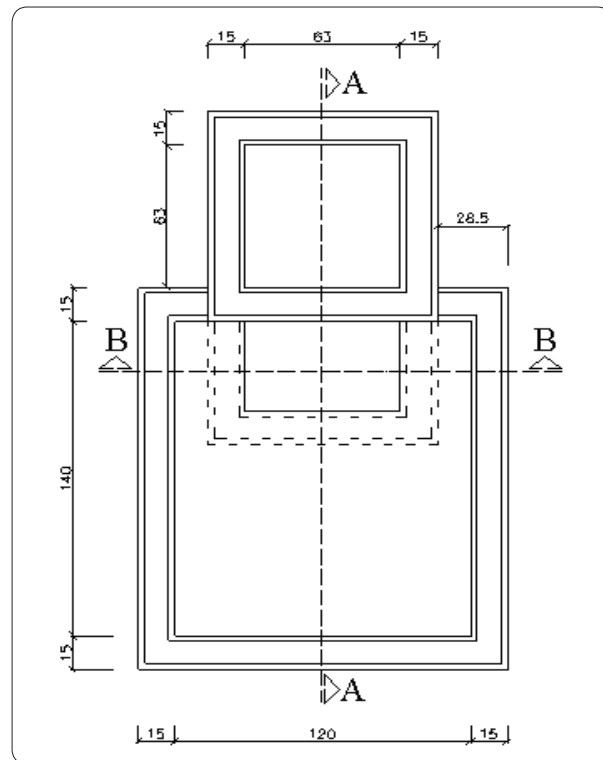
Planta do filtro no nível 2 m (cotas em cm).
